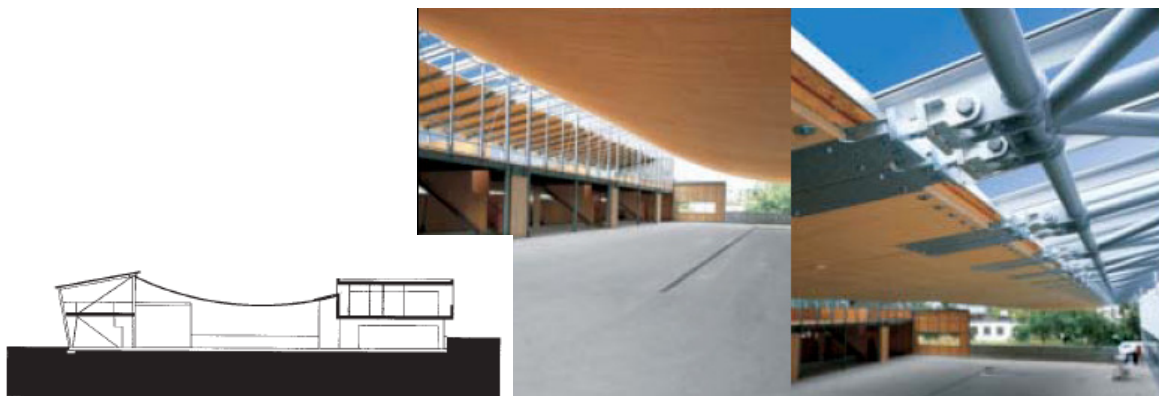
Hala produkcyjna Wilkhahn w Bad Muender-Einbeckhausen. Architektura: Frei Otto, Warmbronn. Konstrukcja: Speich und Hinkes, schemat konstrukcji przekrycia. Realizacja 1987 r, [326], [357].
